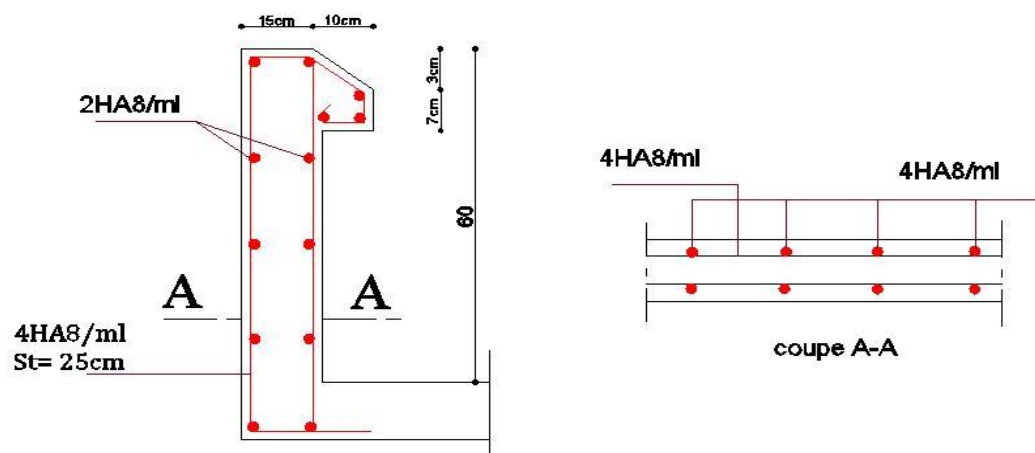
Schéma de ferrailage de l'acrotère (terrasse inaccessible).
